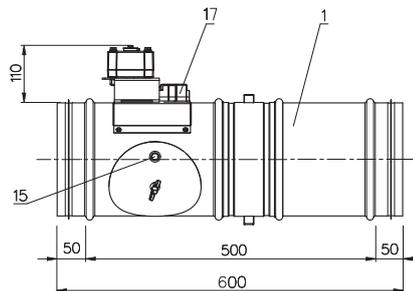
Runde Brandschutzklappe AUSFÜHRUNG MIT STELLANTRIEB
